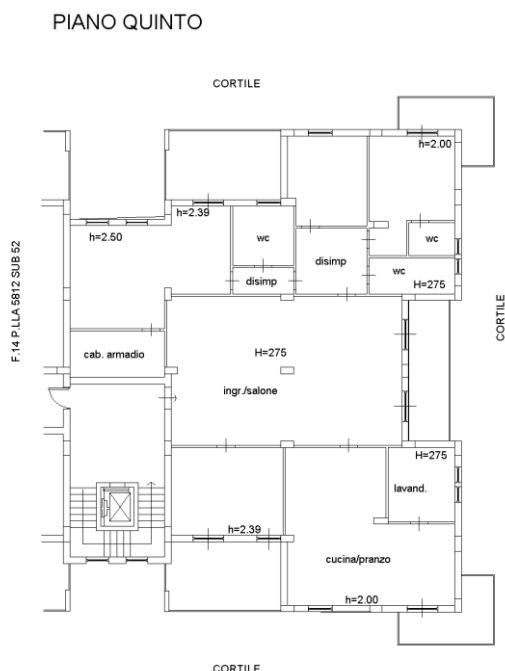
planimetria catastale dell'appartamento mansardato al quinto piano
